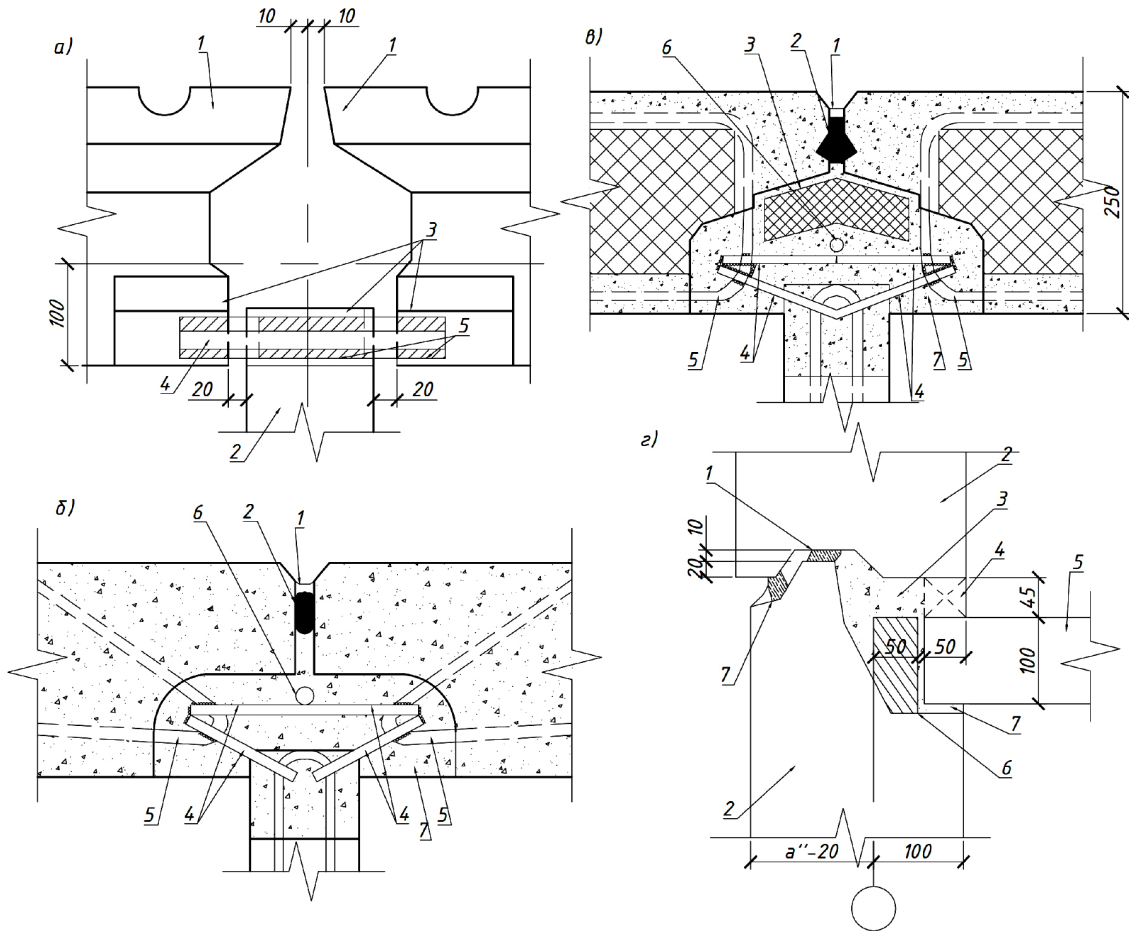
Конструкции стыков наружных стеновых панелей: *a* – вертикального сварного: 1 – наружная стеновая панель; 2 – внутренняя стеновая панель; 3 – закладные детали; 4 – соединительная планка; *б* – то же армированного замоноличенного у однослойных керамзитобетонных панелей; *в* – то же у трехслойных панелей из пороизола: 1 – мастика (герметик); 2 – прокладка из пороизола; 3 – вкладыш из минераловатных плит, обернутый в пергамин, или вкладыш из пенопласта; 4 – скобы диаметром 12 мм; 5 – арматурные петли; 6 – анкер диаметром 12 мм; 7 – тяжелый бетон М200 (класса В15); *г* – горизонтального стыка: 1 – прокладка из пористой резины; 2 – наружная стеновая панель; 3 – цементный раствор состава 1:3; 4 – монтажная прокладка (2 шт. на панель); 5 – панель перекрытия; 6 – вкладыш из минераловатных плит толщиной 50 мм, обернутый в пергамин, или из пенопласта; 7 – зачеканка раствором
